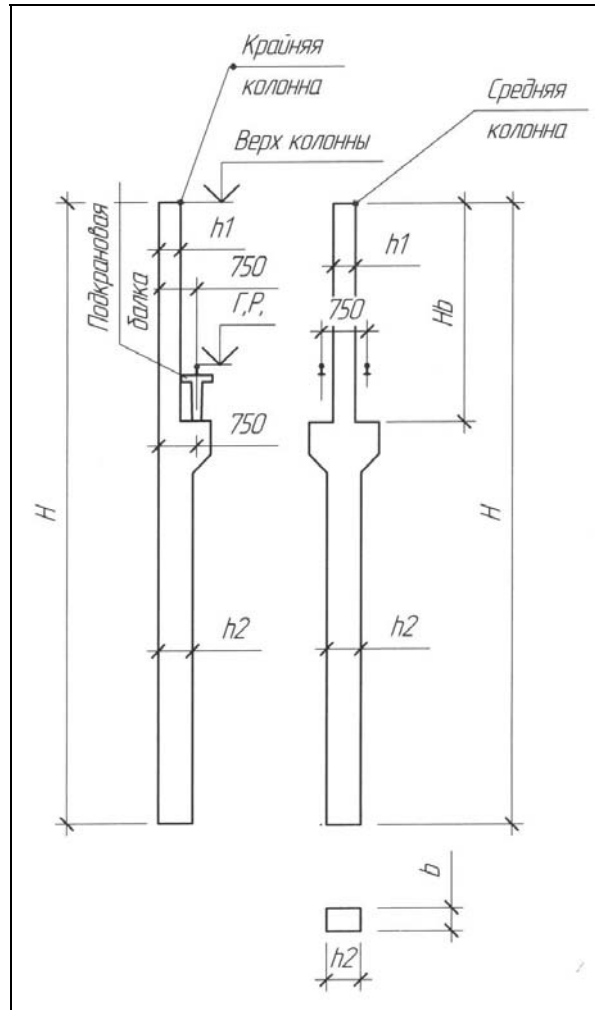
Конструкция колонн прямоугольного сечения для зданий с мостовыми кранами
